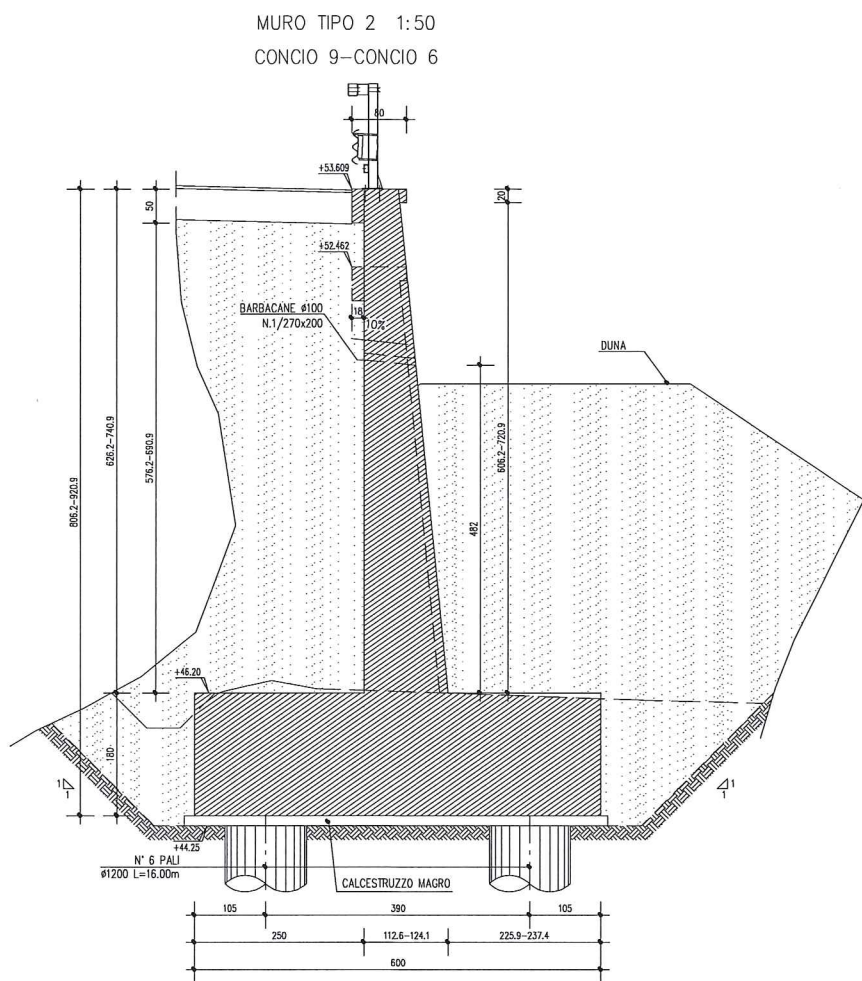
Sezione Tipo - Muro 2 Conci da 6 a 9
